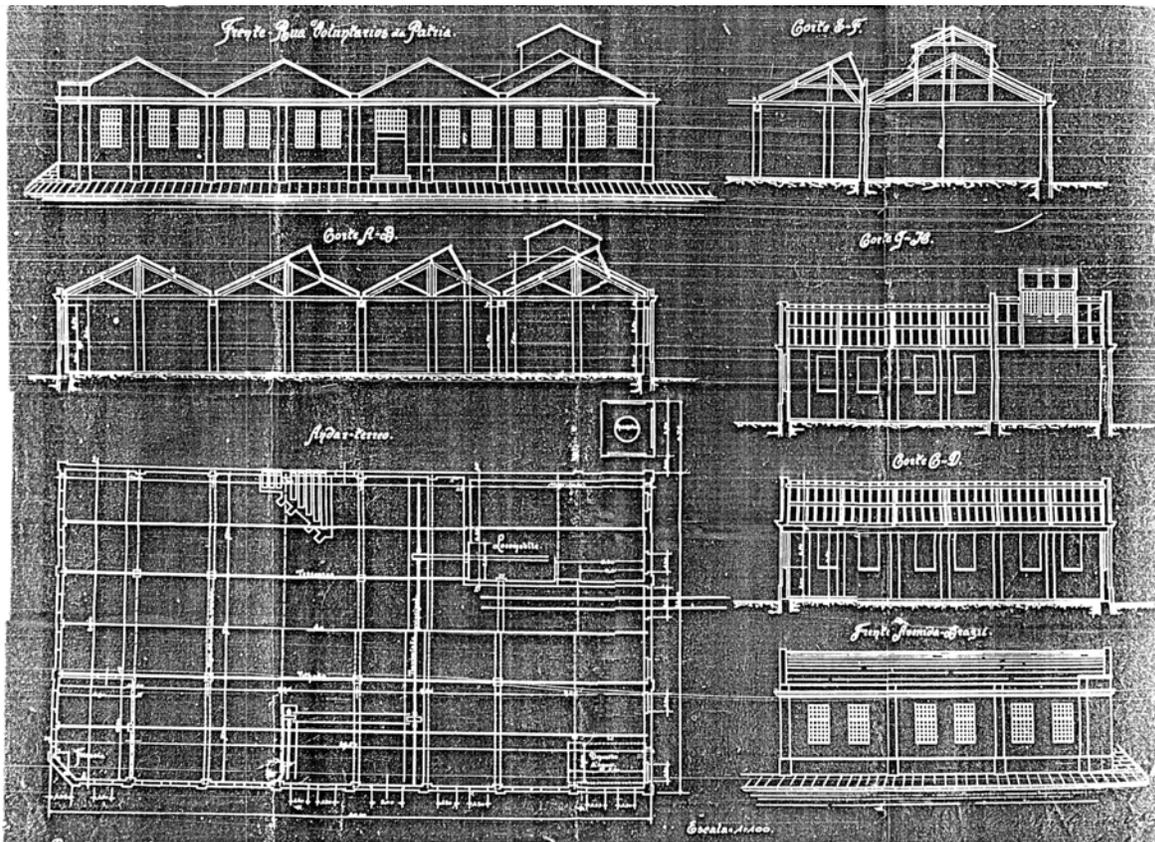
Planta baixa, cortes e fachada dos primeiros quatro módulos do bloco 2. Móveis Gerdau. T. Wiederspahn, 1916.
